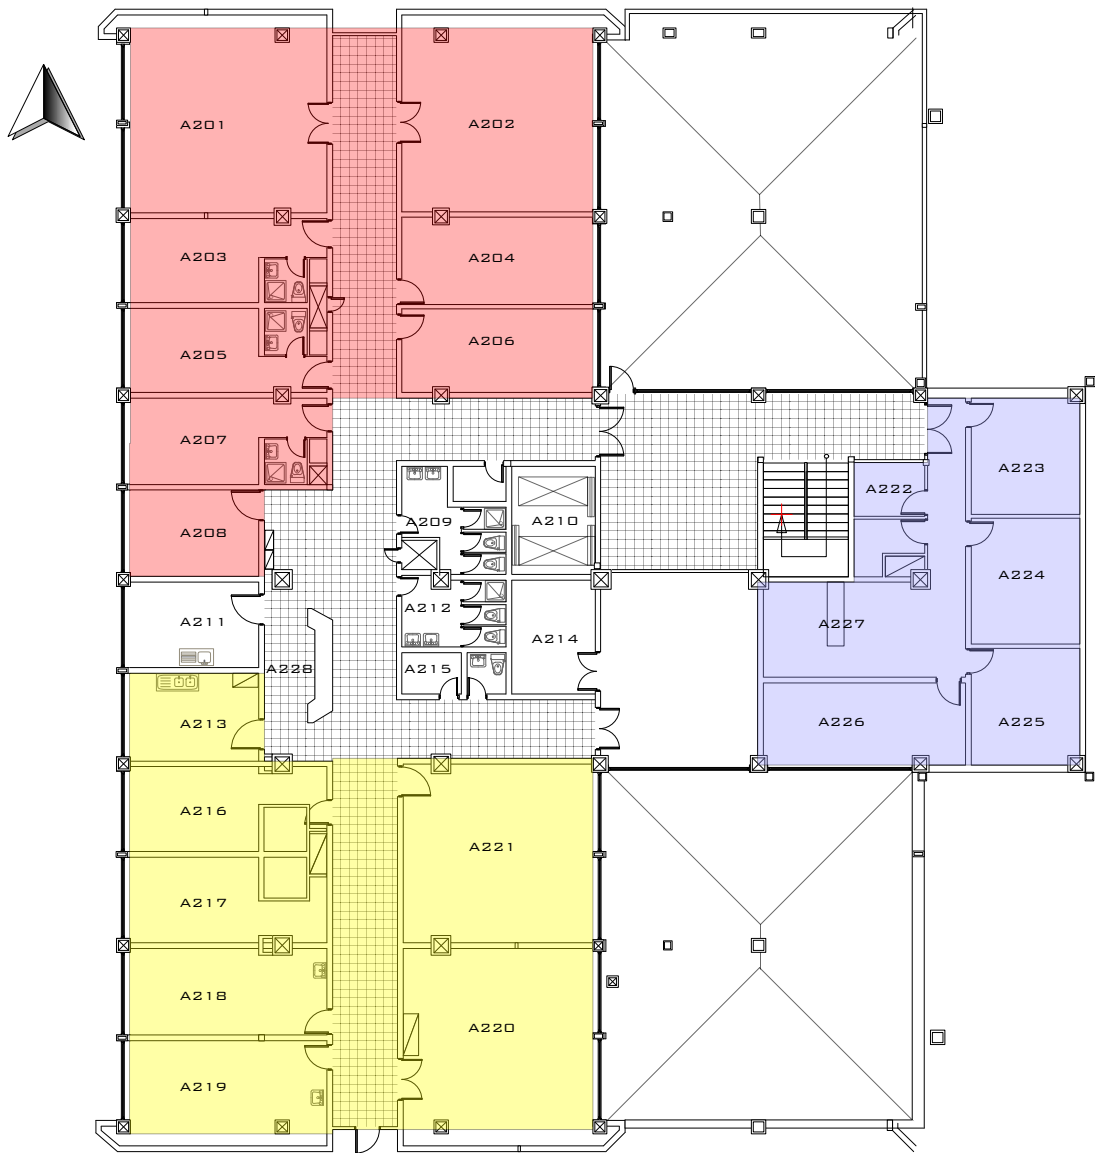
Plano Bloque A - 1ra. Planta Alta
